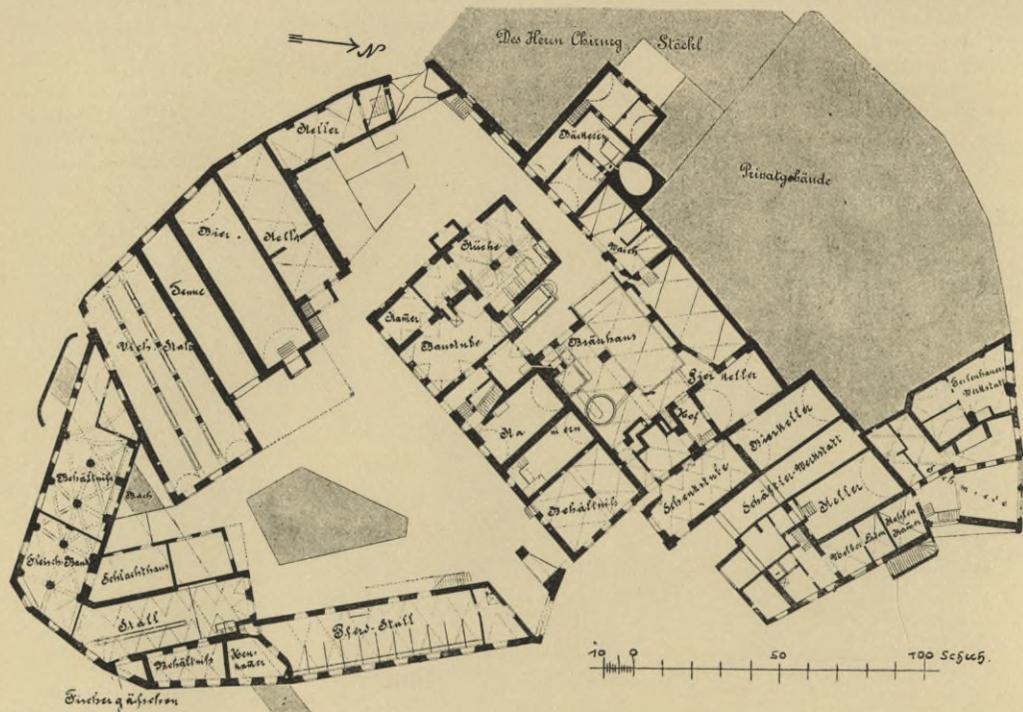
Das Heiliggeistspital um 1600. Erdgeschoß-Grundriß der Oekonomiegebäude.
